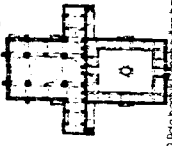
Bentuk vault pada ss dalam bangunan sumber domain architectur
